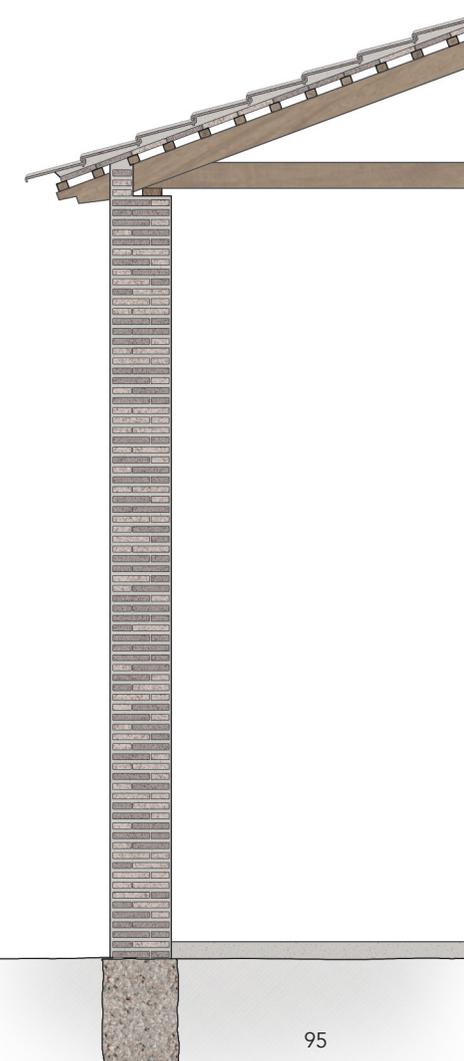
Sección constructiva parcial de la nave realizada con muros de ladrillo y cubierta de cerchas con tablero de rasilla y teja plana.
